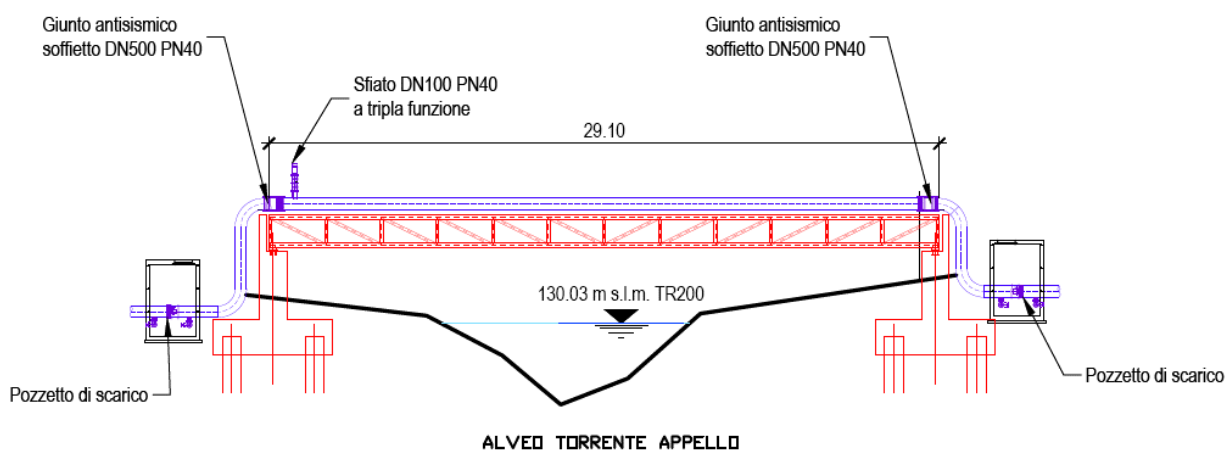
Sezione longitudinale attraversamento aereo di progetto sul Fiume Appello
